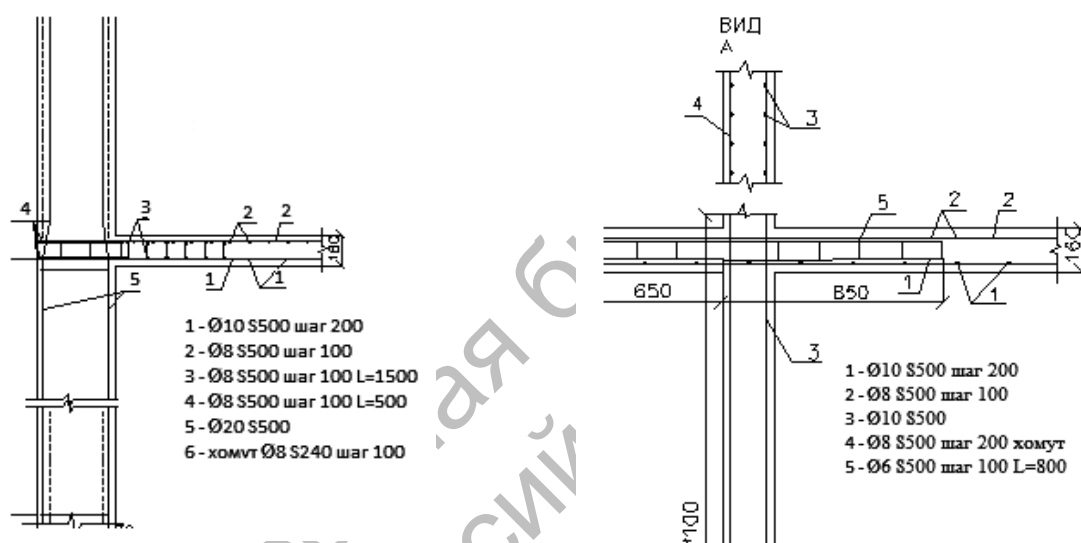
Узлы сопряжения плиты перекрытия с вертикальными конструкциями
